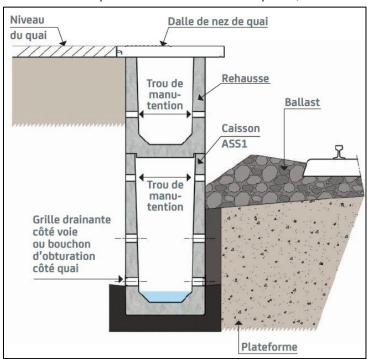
Principe en coupe d'un quai drainant (source : Bonna Sabla)
